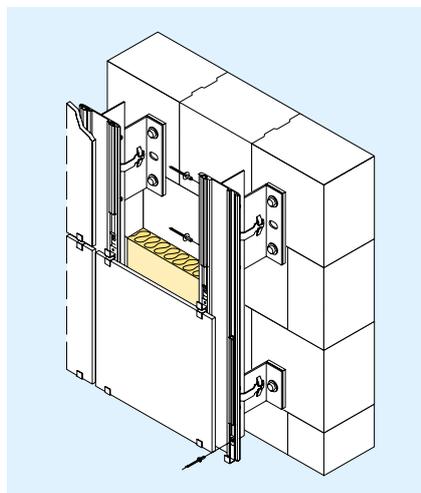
Aluminium-Unterkonstruktion mit Wandhaltern
